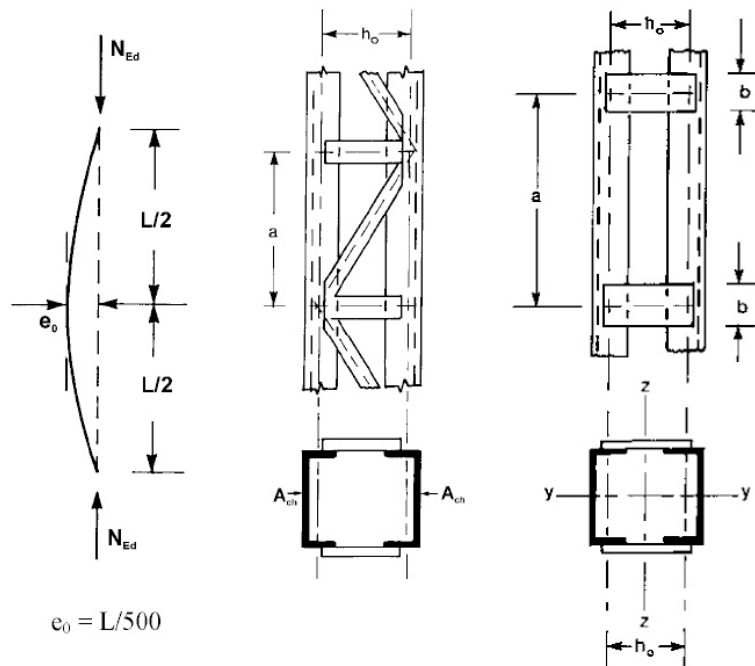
Pilares de sección compuesta constante con celosías y presillas
